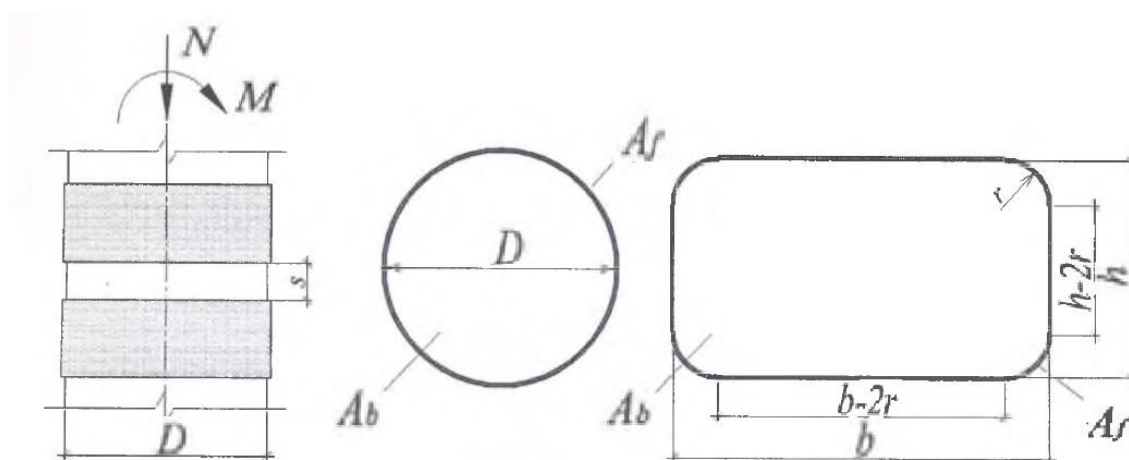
Расчетная схема для композитного усиления круглых и прямоугольных сечений в поперечном направлении
